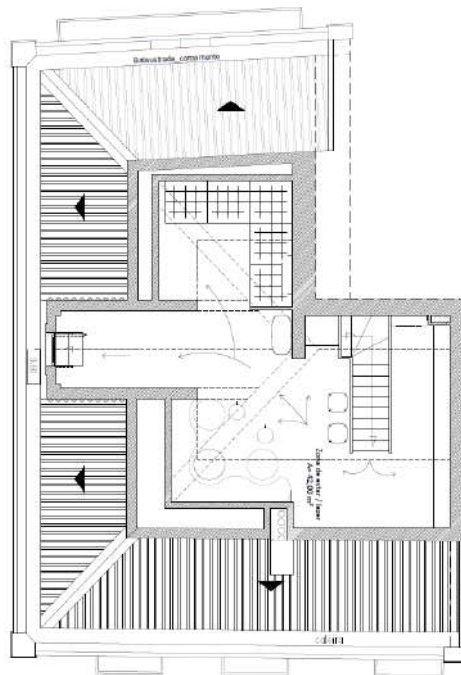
Planta de Zonamento e Circulação - Piso das Águas-Furtadas
